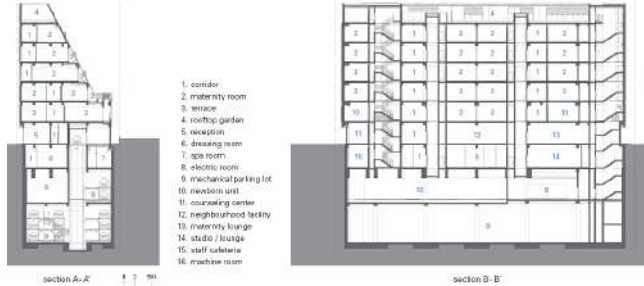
Potongan Bangunan Aiyue Postpartum Care Center Sumber: ArchDaily, 2020 3 lantai
